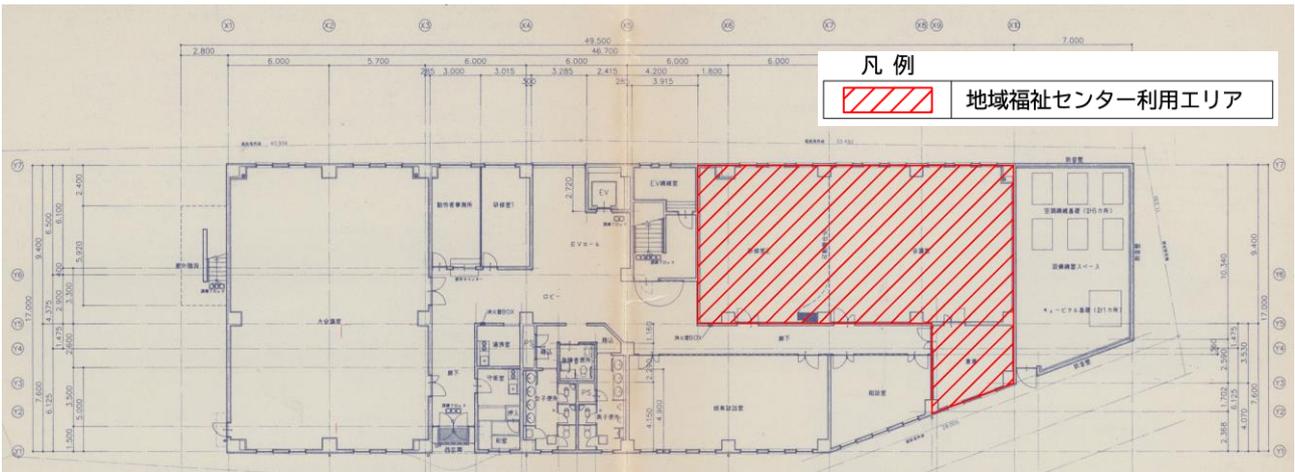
地域福祉センター 機能位置図 (案) 1階平面図
